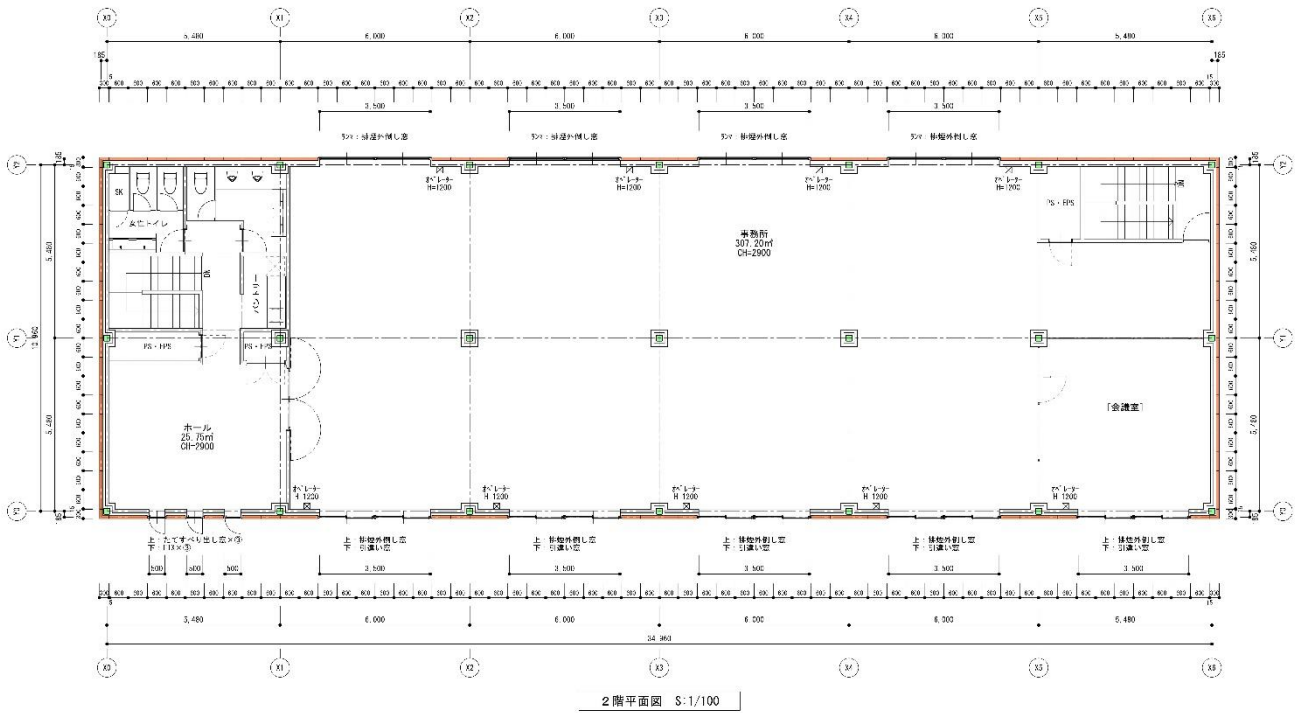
CLT 床パネルの配置例 (1) 2階平面図
